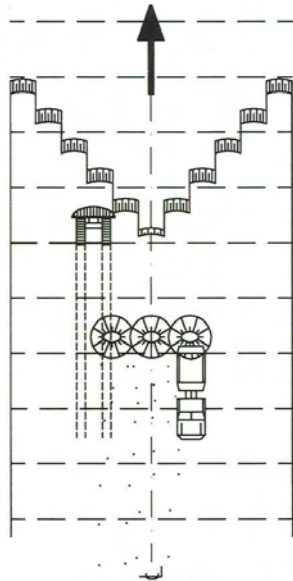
18 Fylling på geotekstil over bløt grunn.
